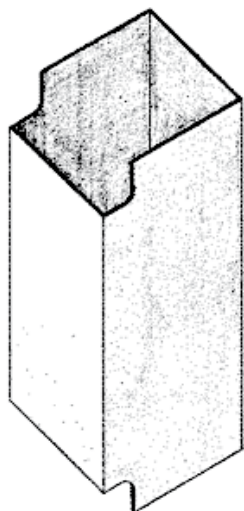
Оболочка трубобетонного элемента квадратного поперечного сечения с вырезами
